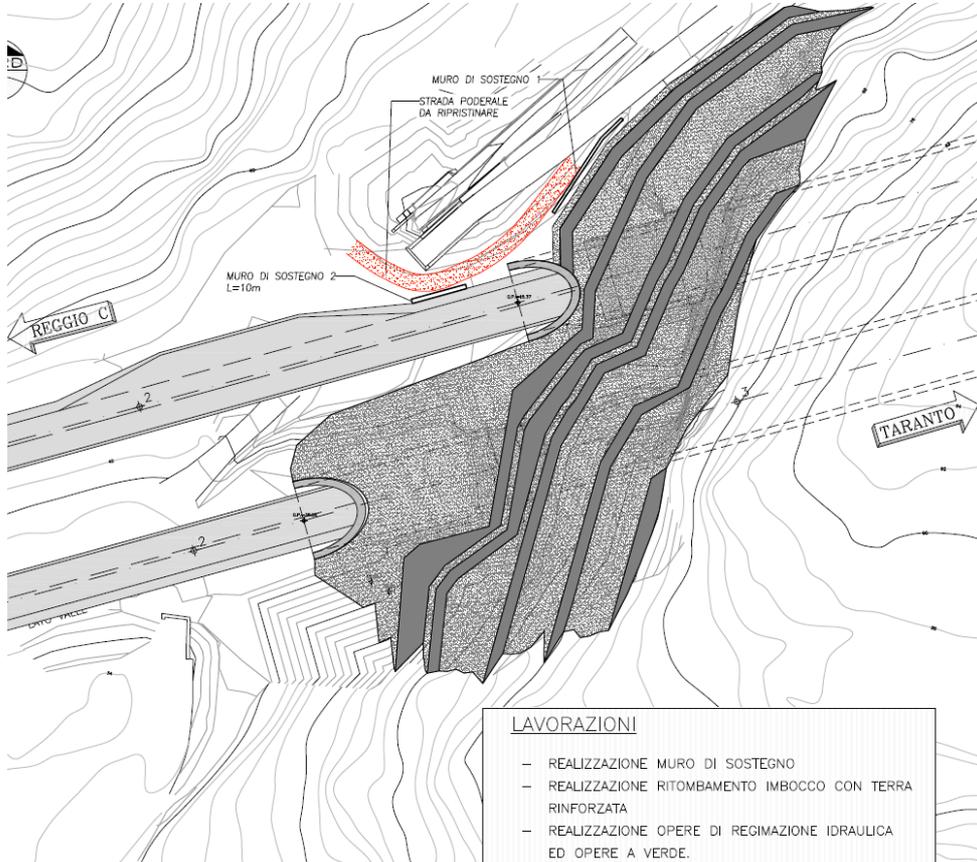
Galleria Peristeri – Fase 3 sistemazione finale – Lato RC
